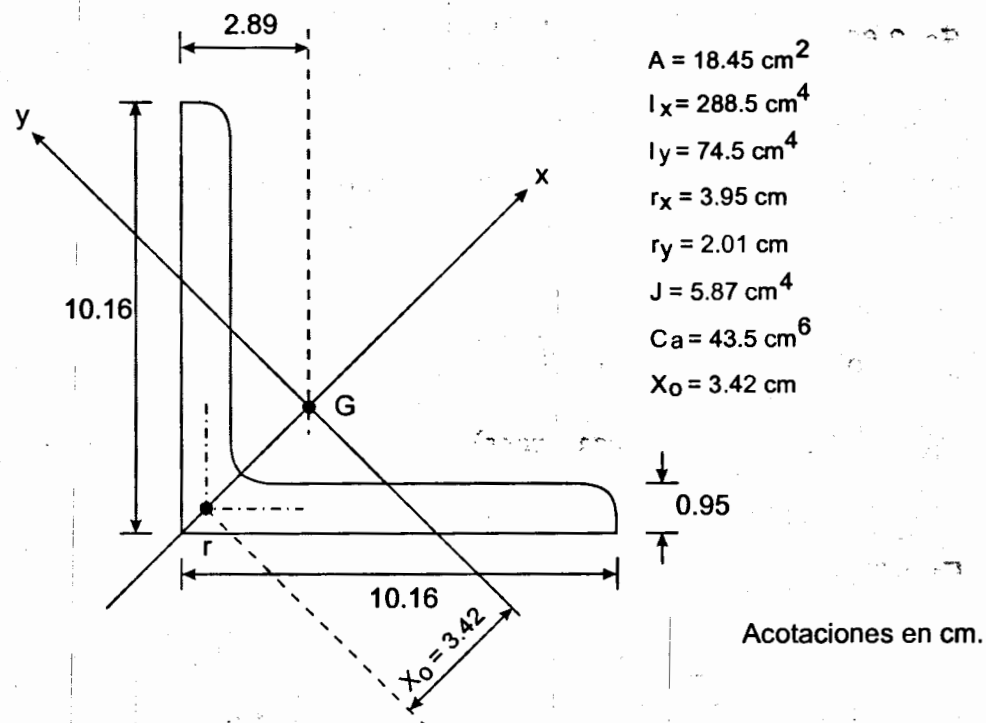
Sección transversal y propiedades geométricas de la columna del ejemplo 2.6.
